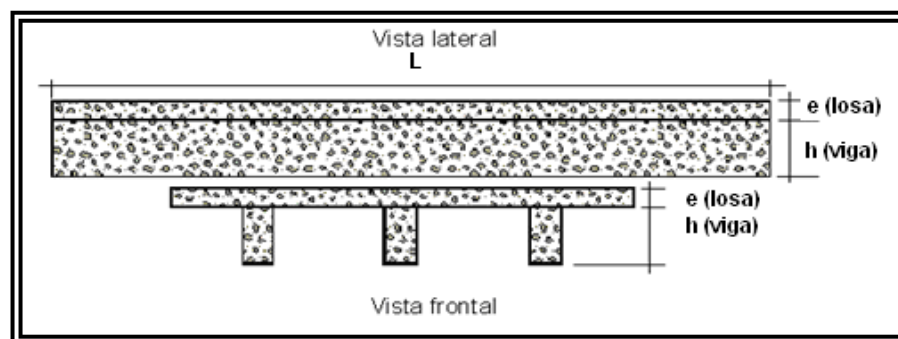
Puente con vigas longitudinales de concreto reforzado⁵³.
